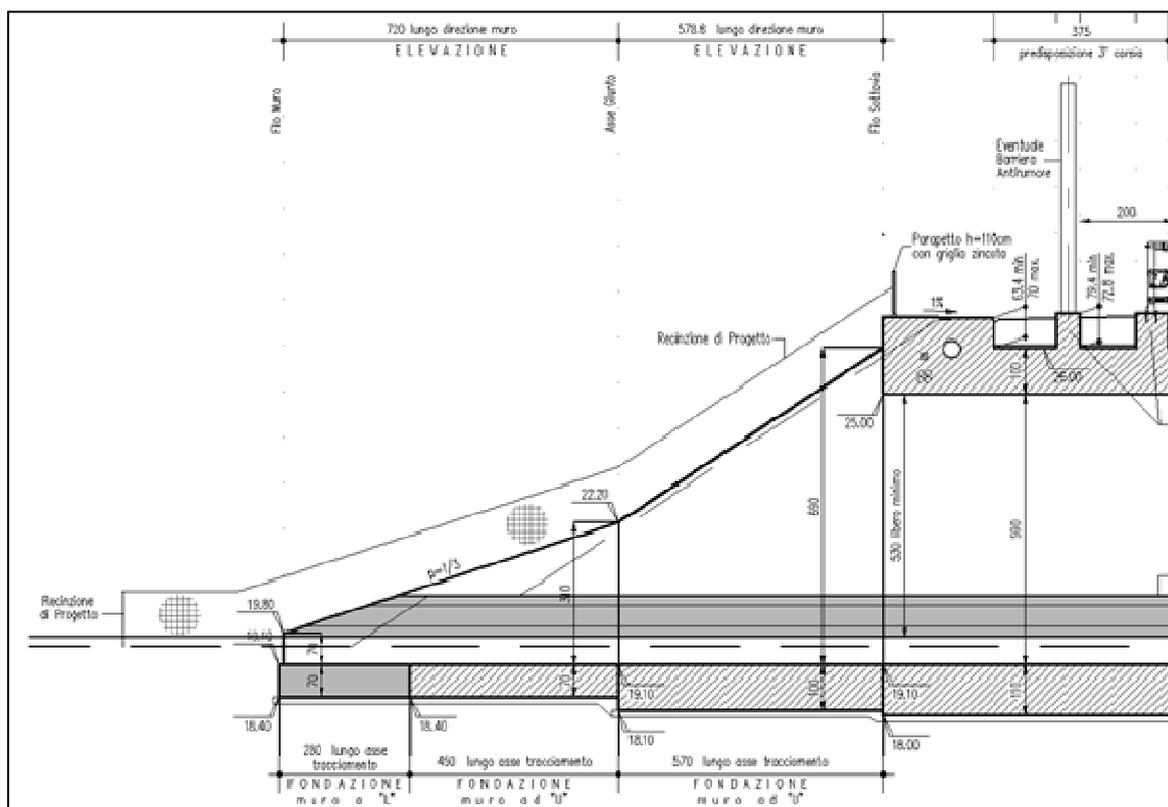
PARTICOLARE IMBOCCO SOTTOVIA
